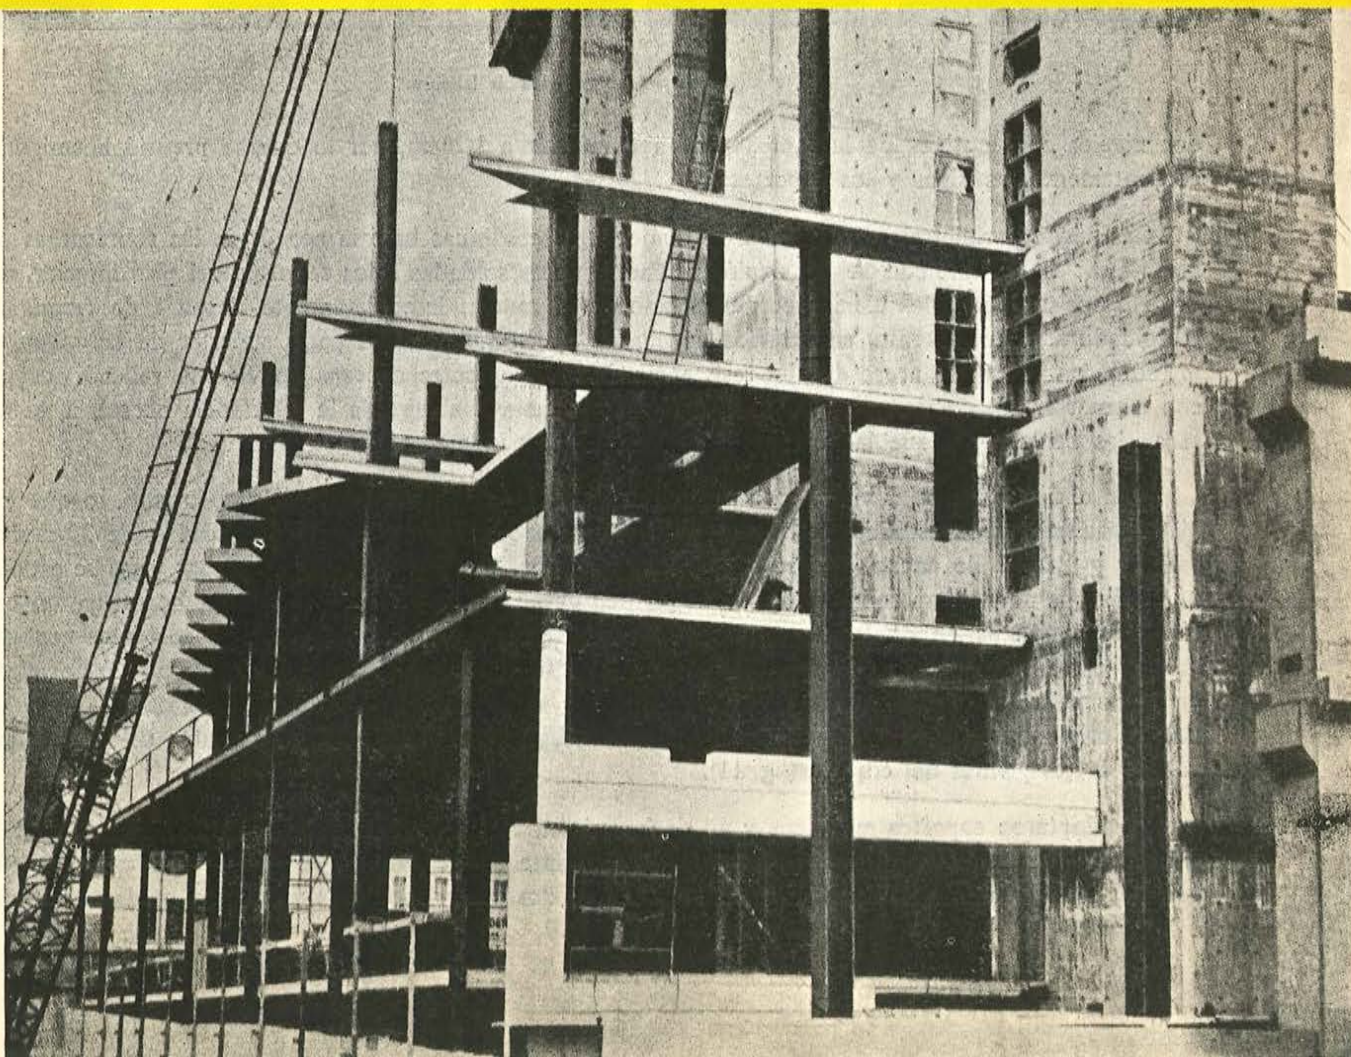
Colocación de las losas del forjado sobre las vigas de arriostramiento. Las losas voladas del lado izquierdo dan ya idea del movimiento de la fachada. Puede verse, asimismo, la estructura de la rampa de acceso entre plantas a distinto nivel. Los soportes metálicos tienen una longitud igual a la altura de tres plantas. Se aprecian las uniones correspondientes a cada tres plantas.
